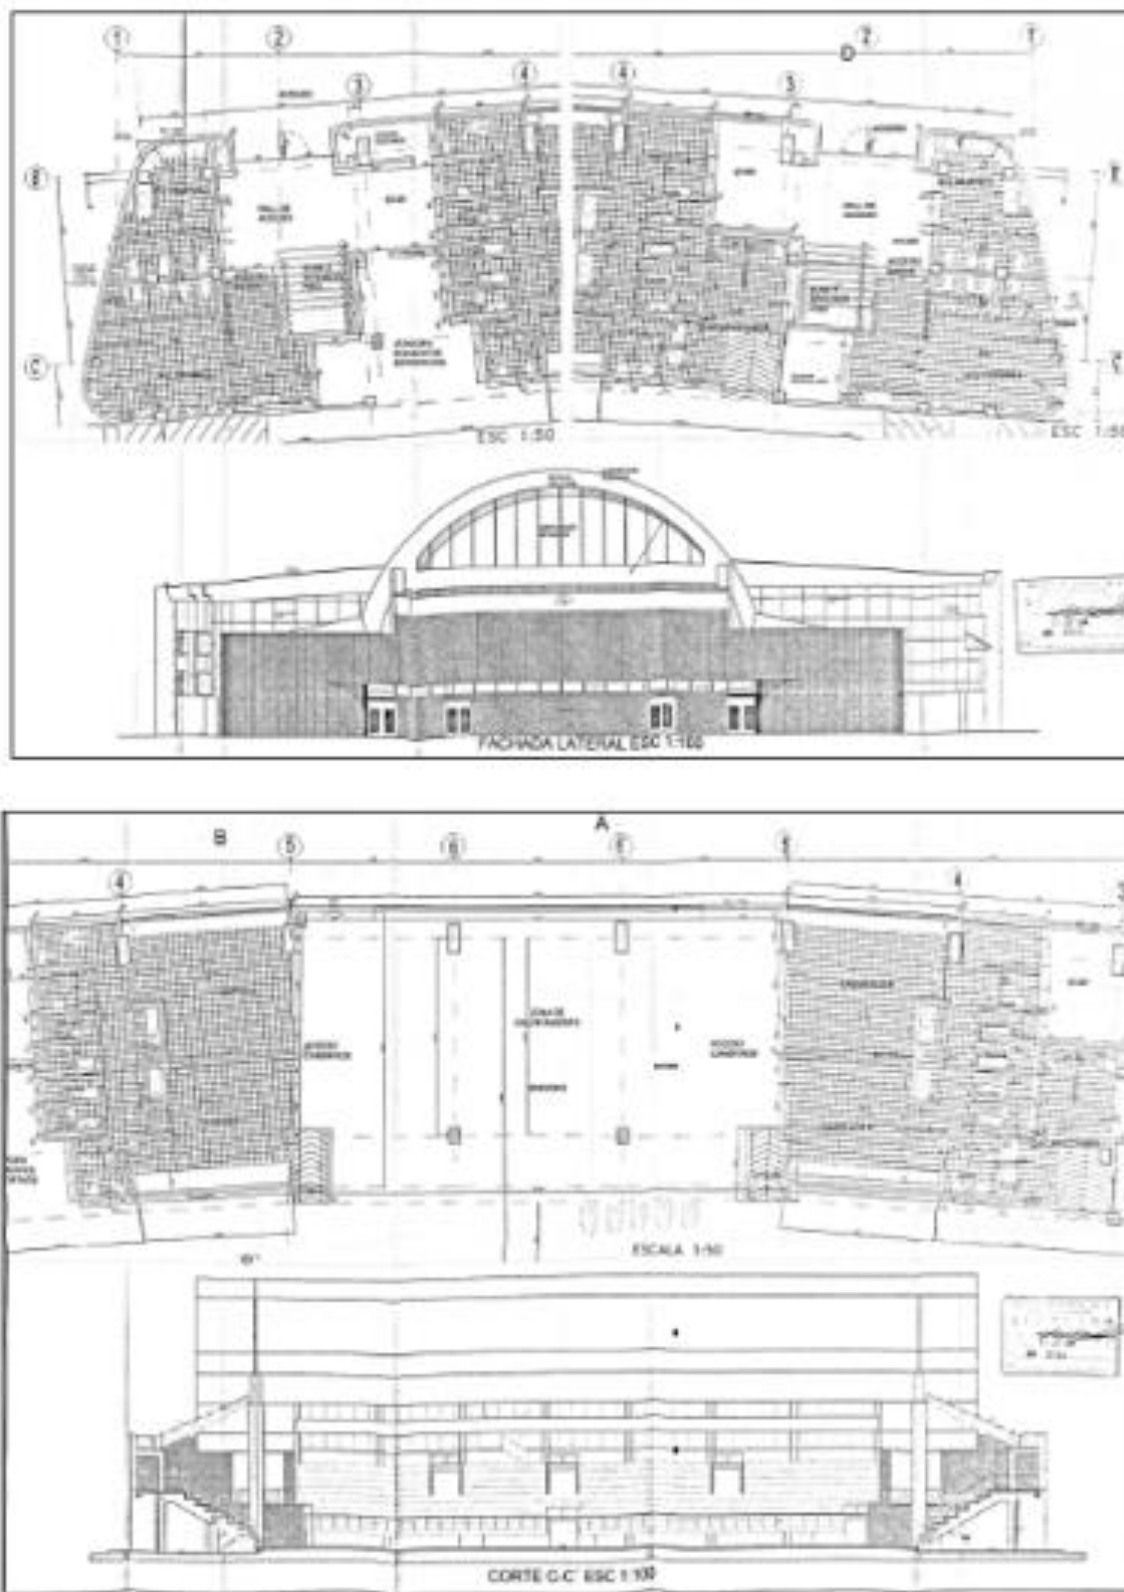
Corte Fachada lateral y Transversal Coliseo León XIII.
